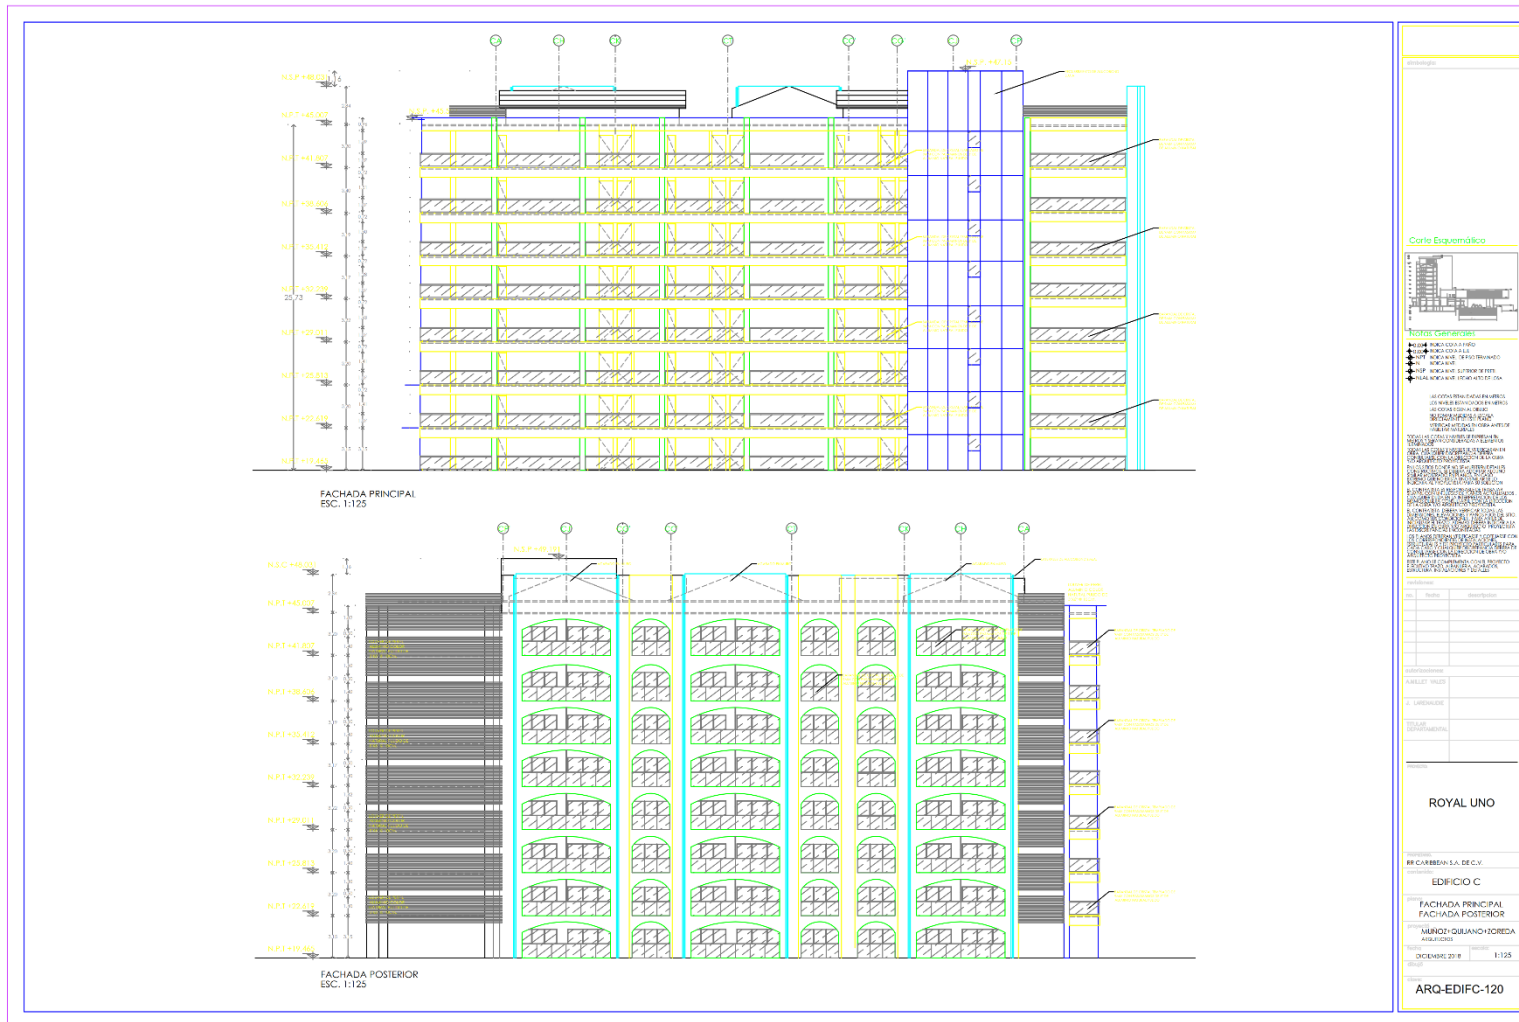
Edificio C, Fachada posterior y principal. Anexo C-7.
